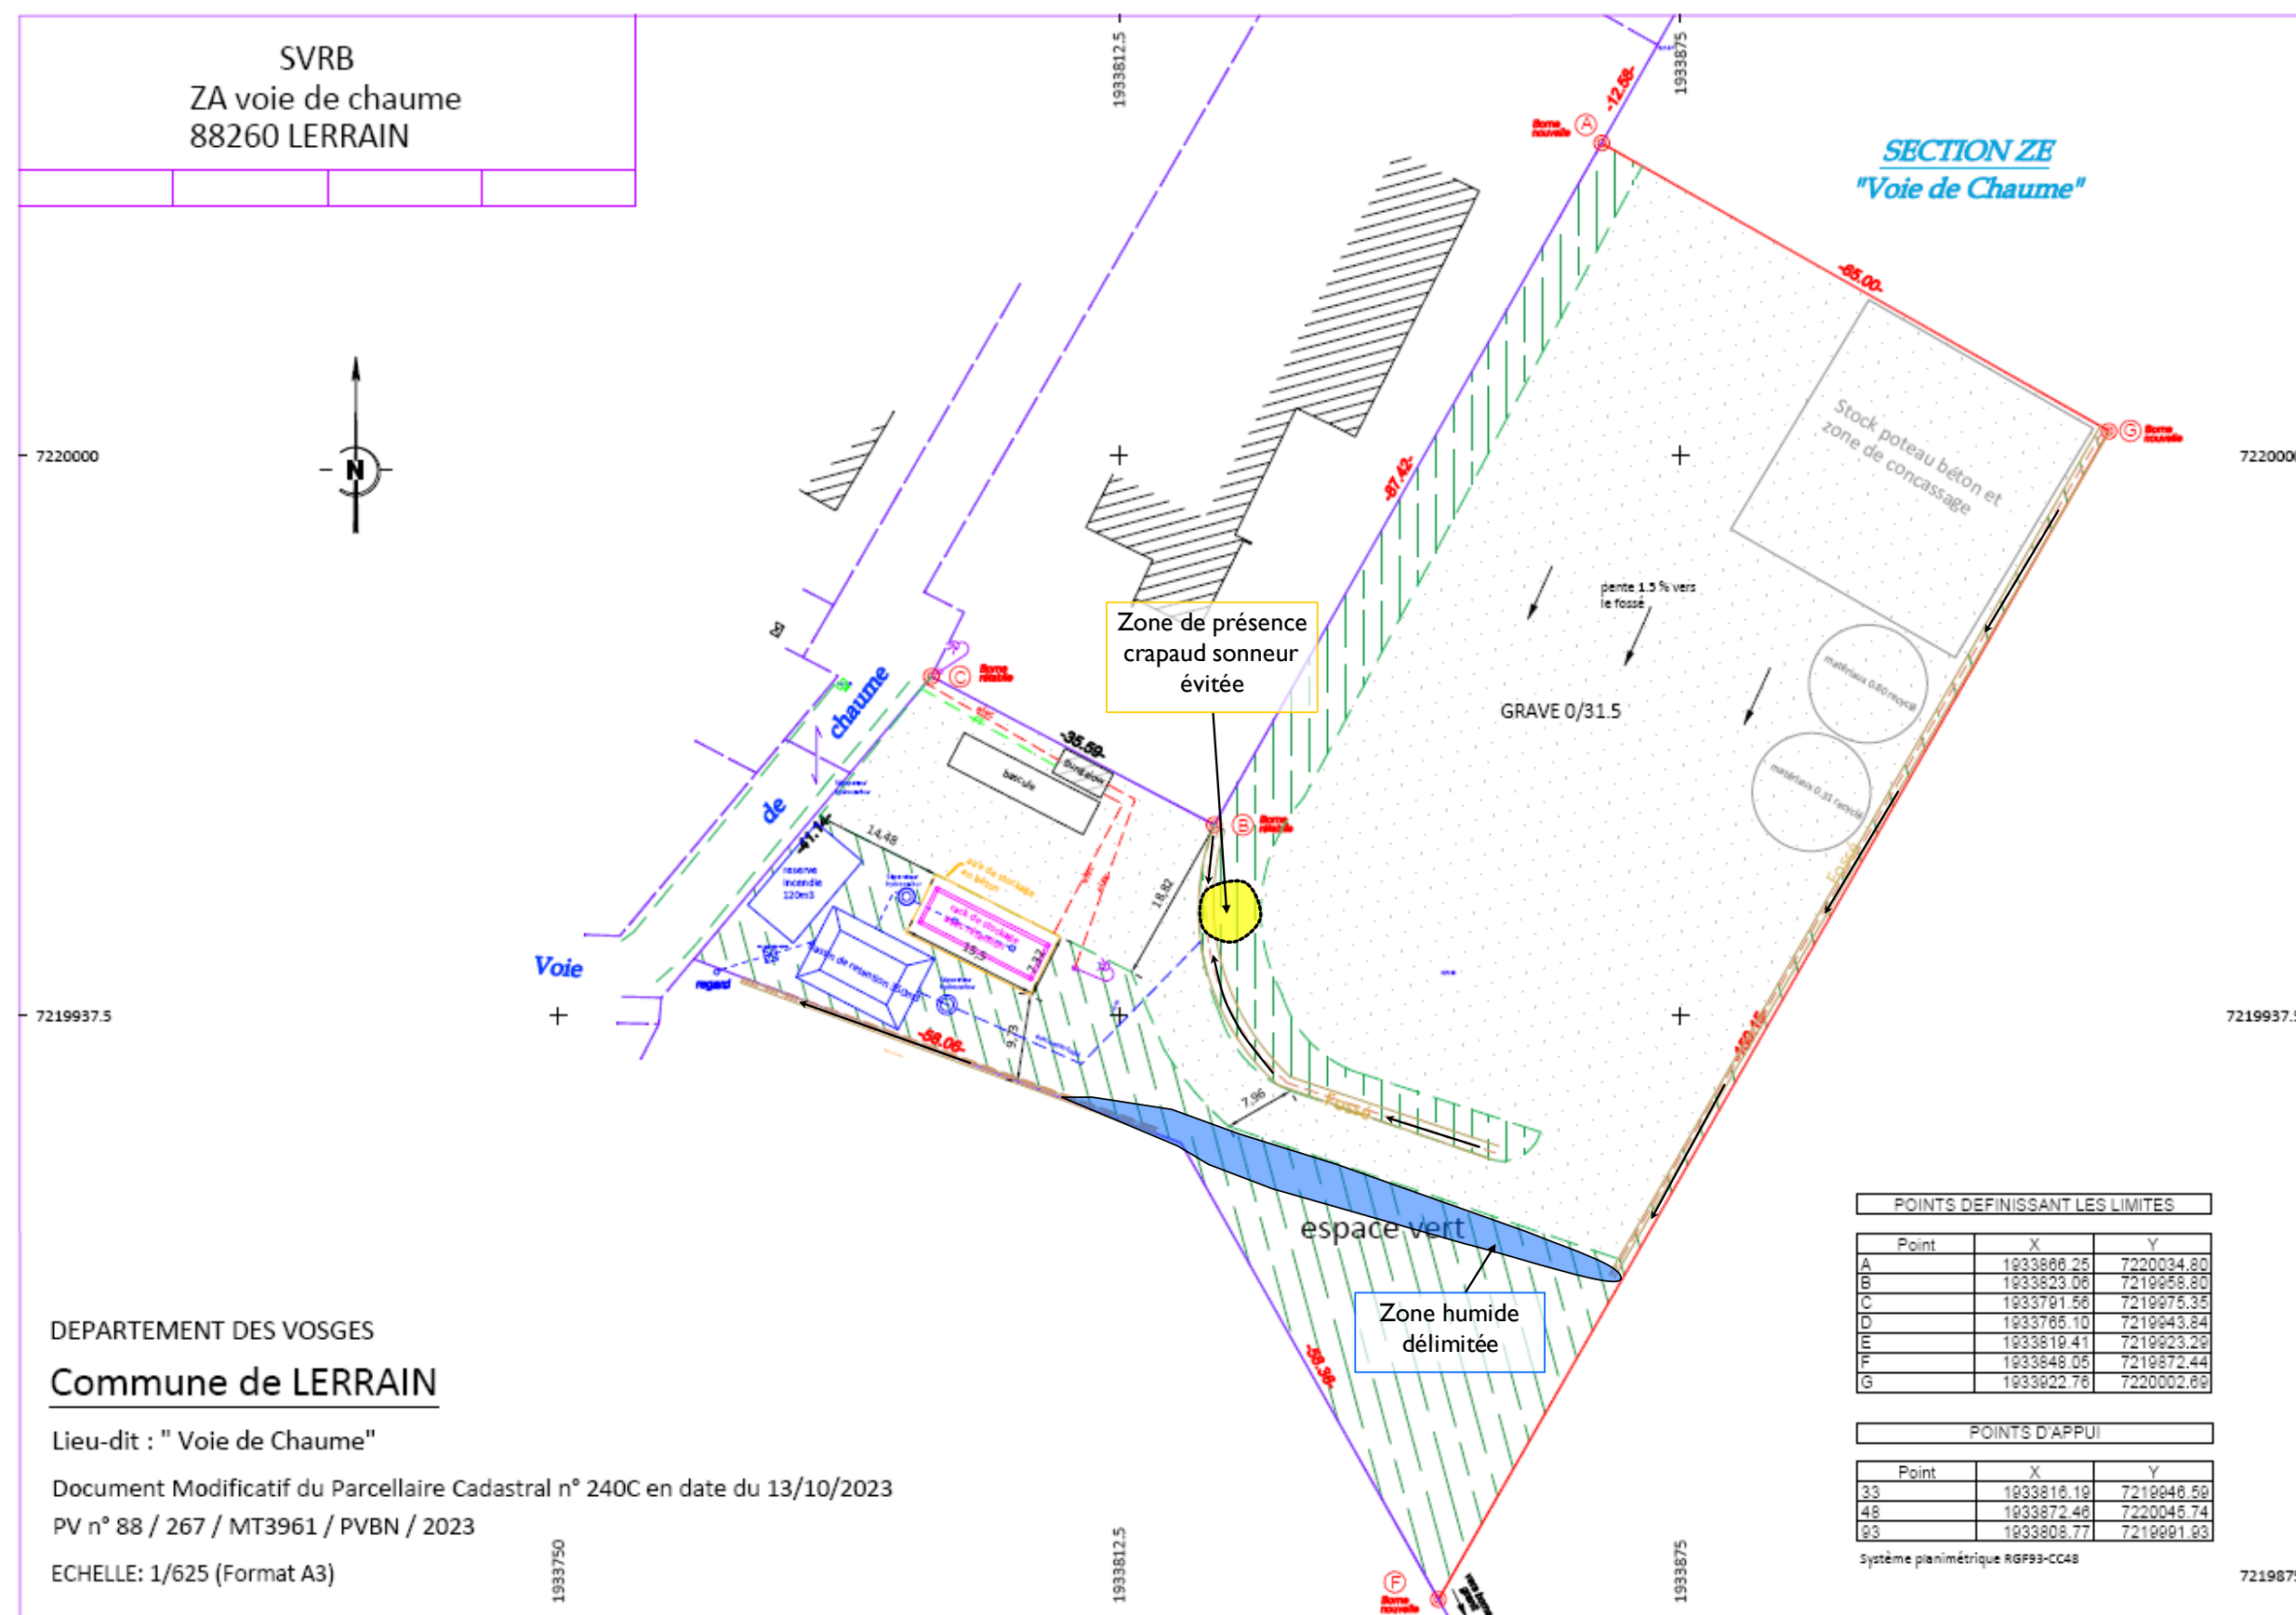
Extrait du plan de masse du projet de plateforme de broyage avec zones à enjeux préservées (Source : D'après SVRB)
